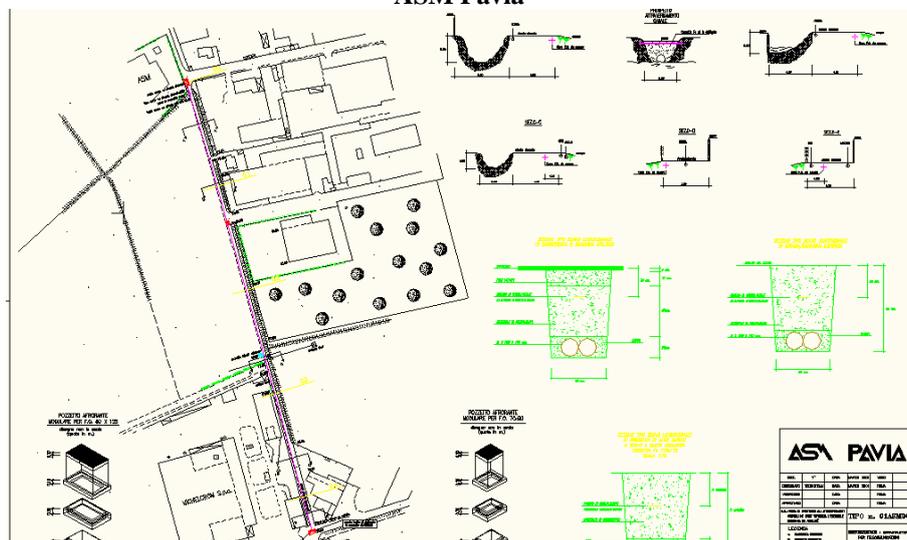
32 - Cavidotti: particolari della rappresentazione sul sito ed estratto da tavola di progetto
